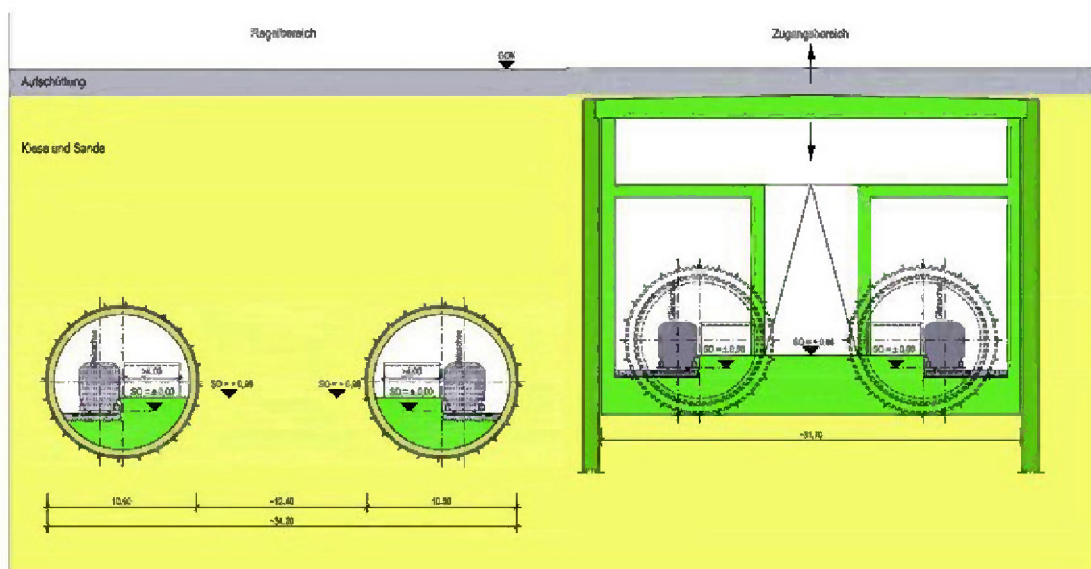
Bau einer Haltestelle mit Bahnhofsschild
